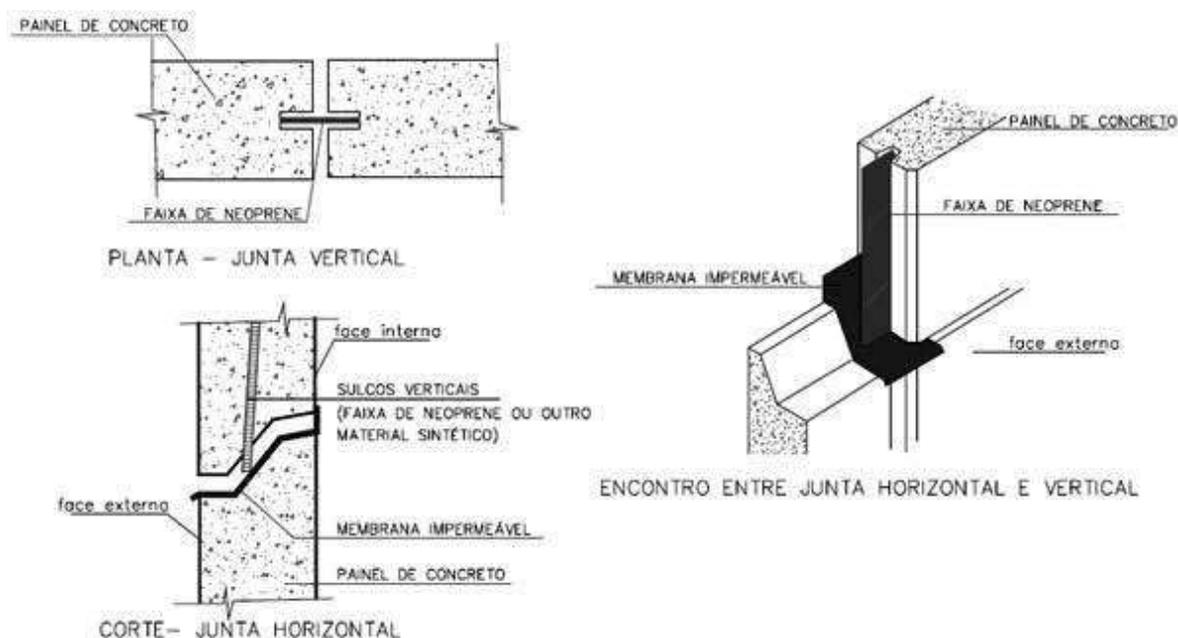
Detalhe de junta de drenagem e membrana estanques utilizadas nas juntas horizontais. (OLIVEIRA, 2002)
